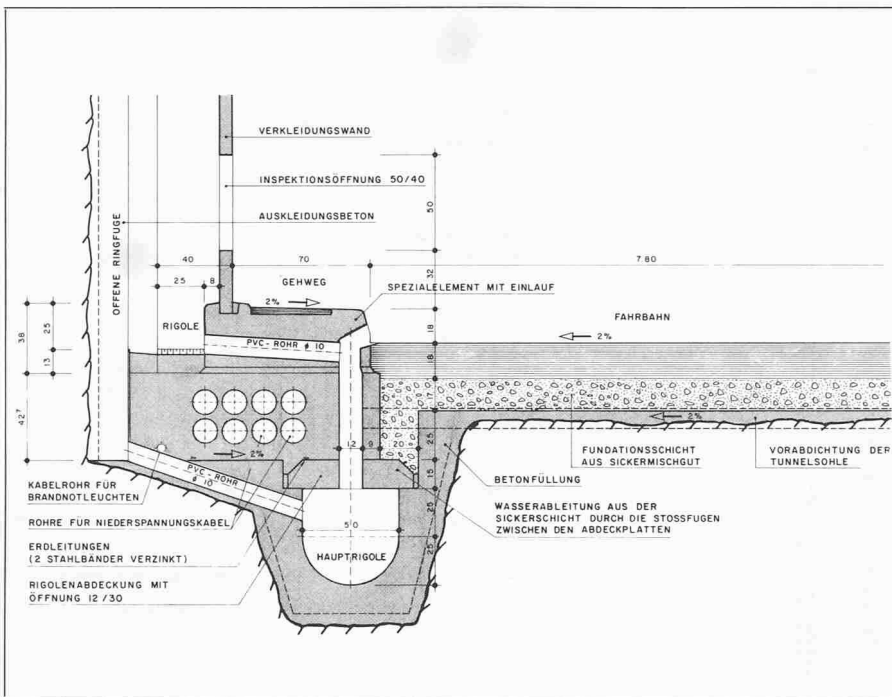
Querschnitt unterer Fahrbahnrandabschluss mit Ringfugen- und Strasseneinlauf alle 8 m
